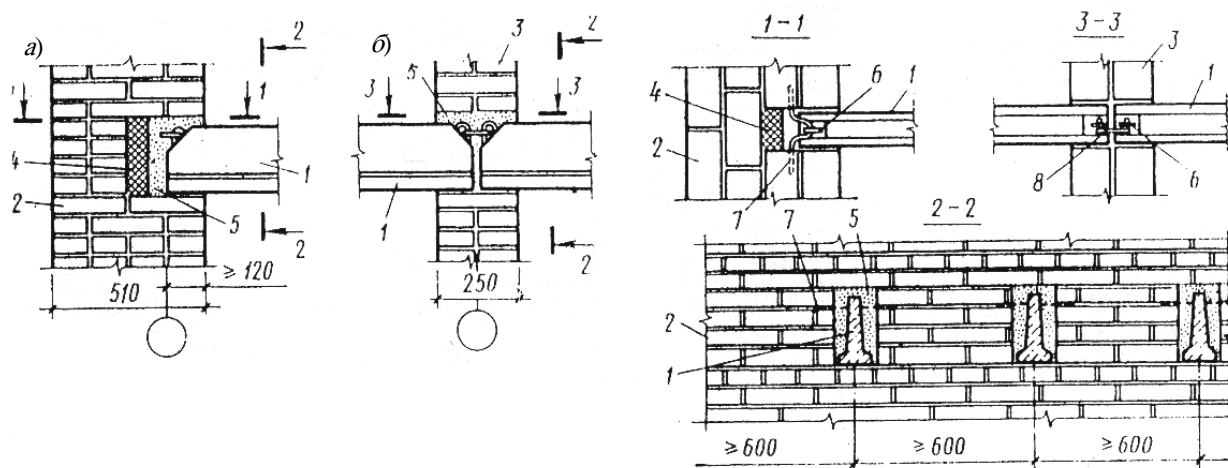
Опираие железобетонных балок перекрытий на каменные стены:
